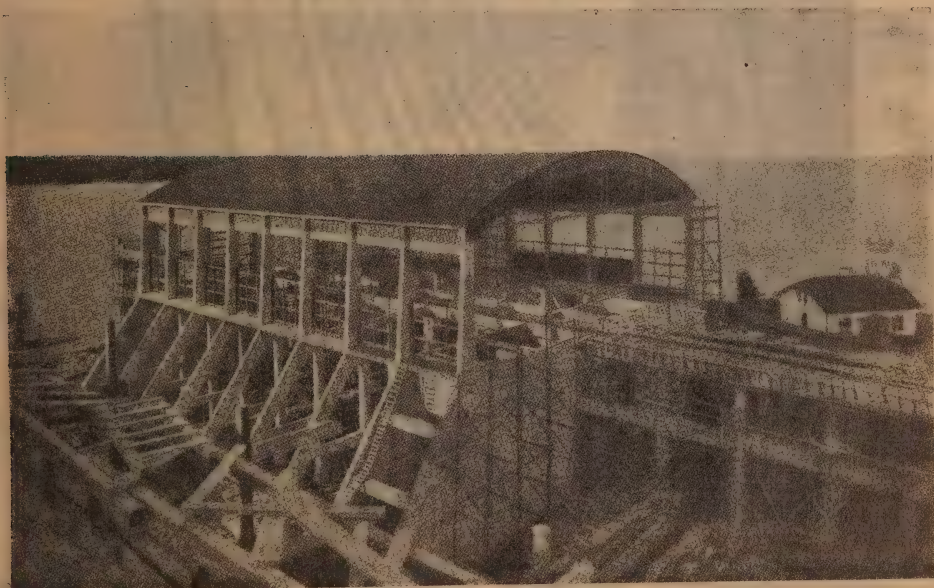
центральный вокзал в Копенгагене, перекрытый фермами Стефан, шесть пролетов по 25 метр. каждый; затяжки металлические.
